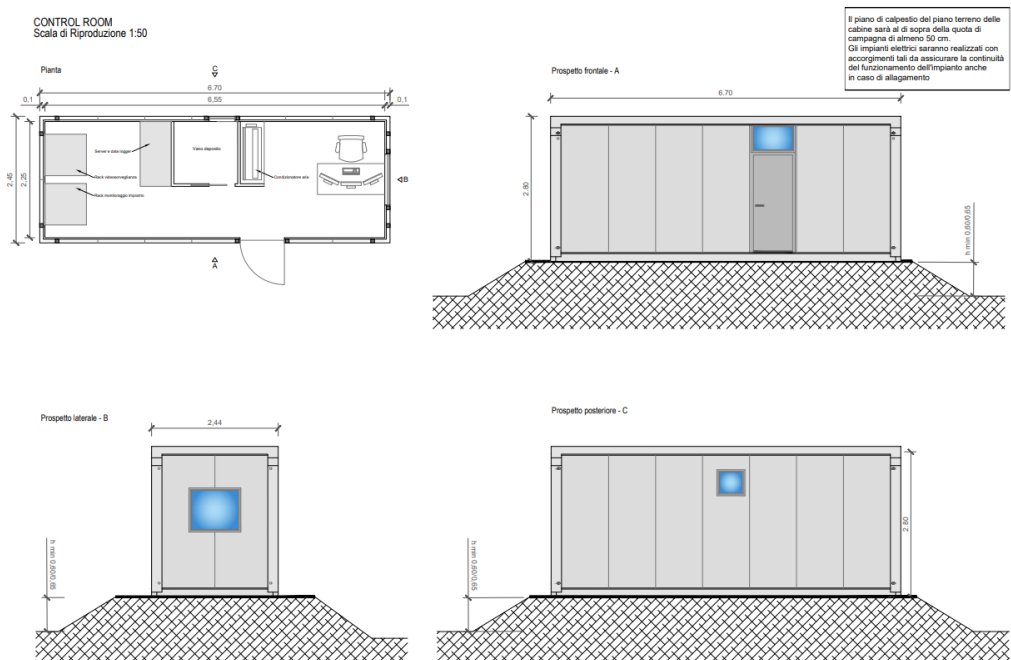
Pianta e prospetti cabina di controllo (Control Room)
